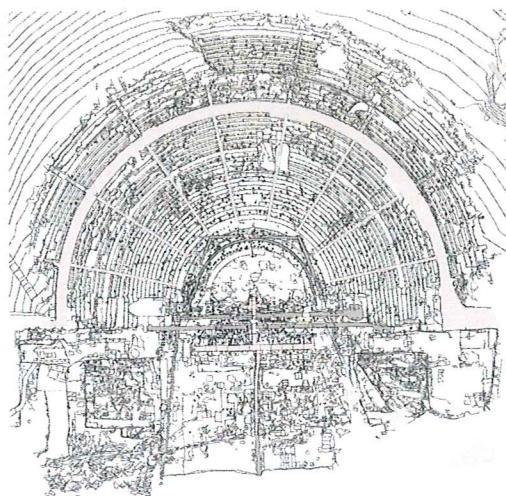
Teatro greco di Siracusa, restituzione in pianta
